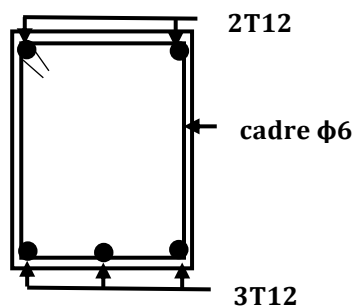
Schéma de ferrailage de la poutre palière(var1)
